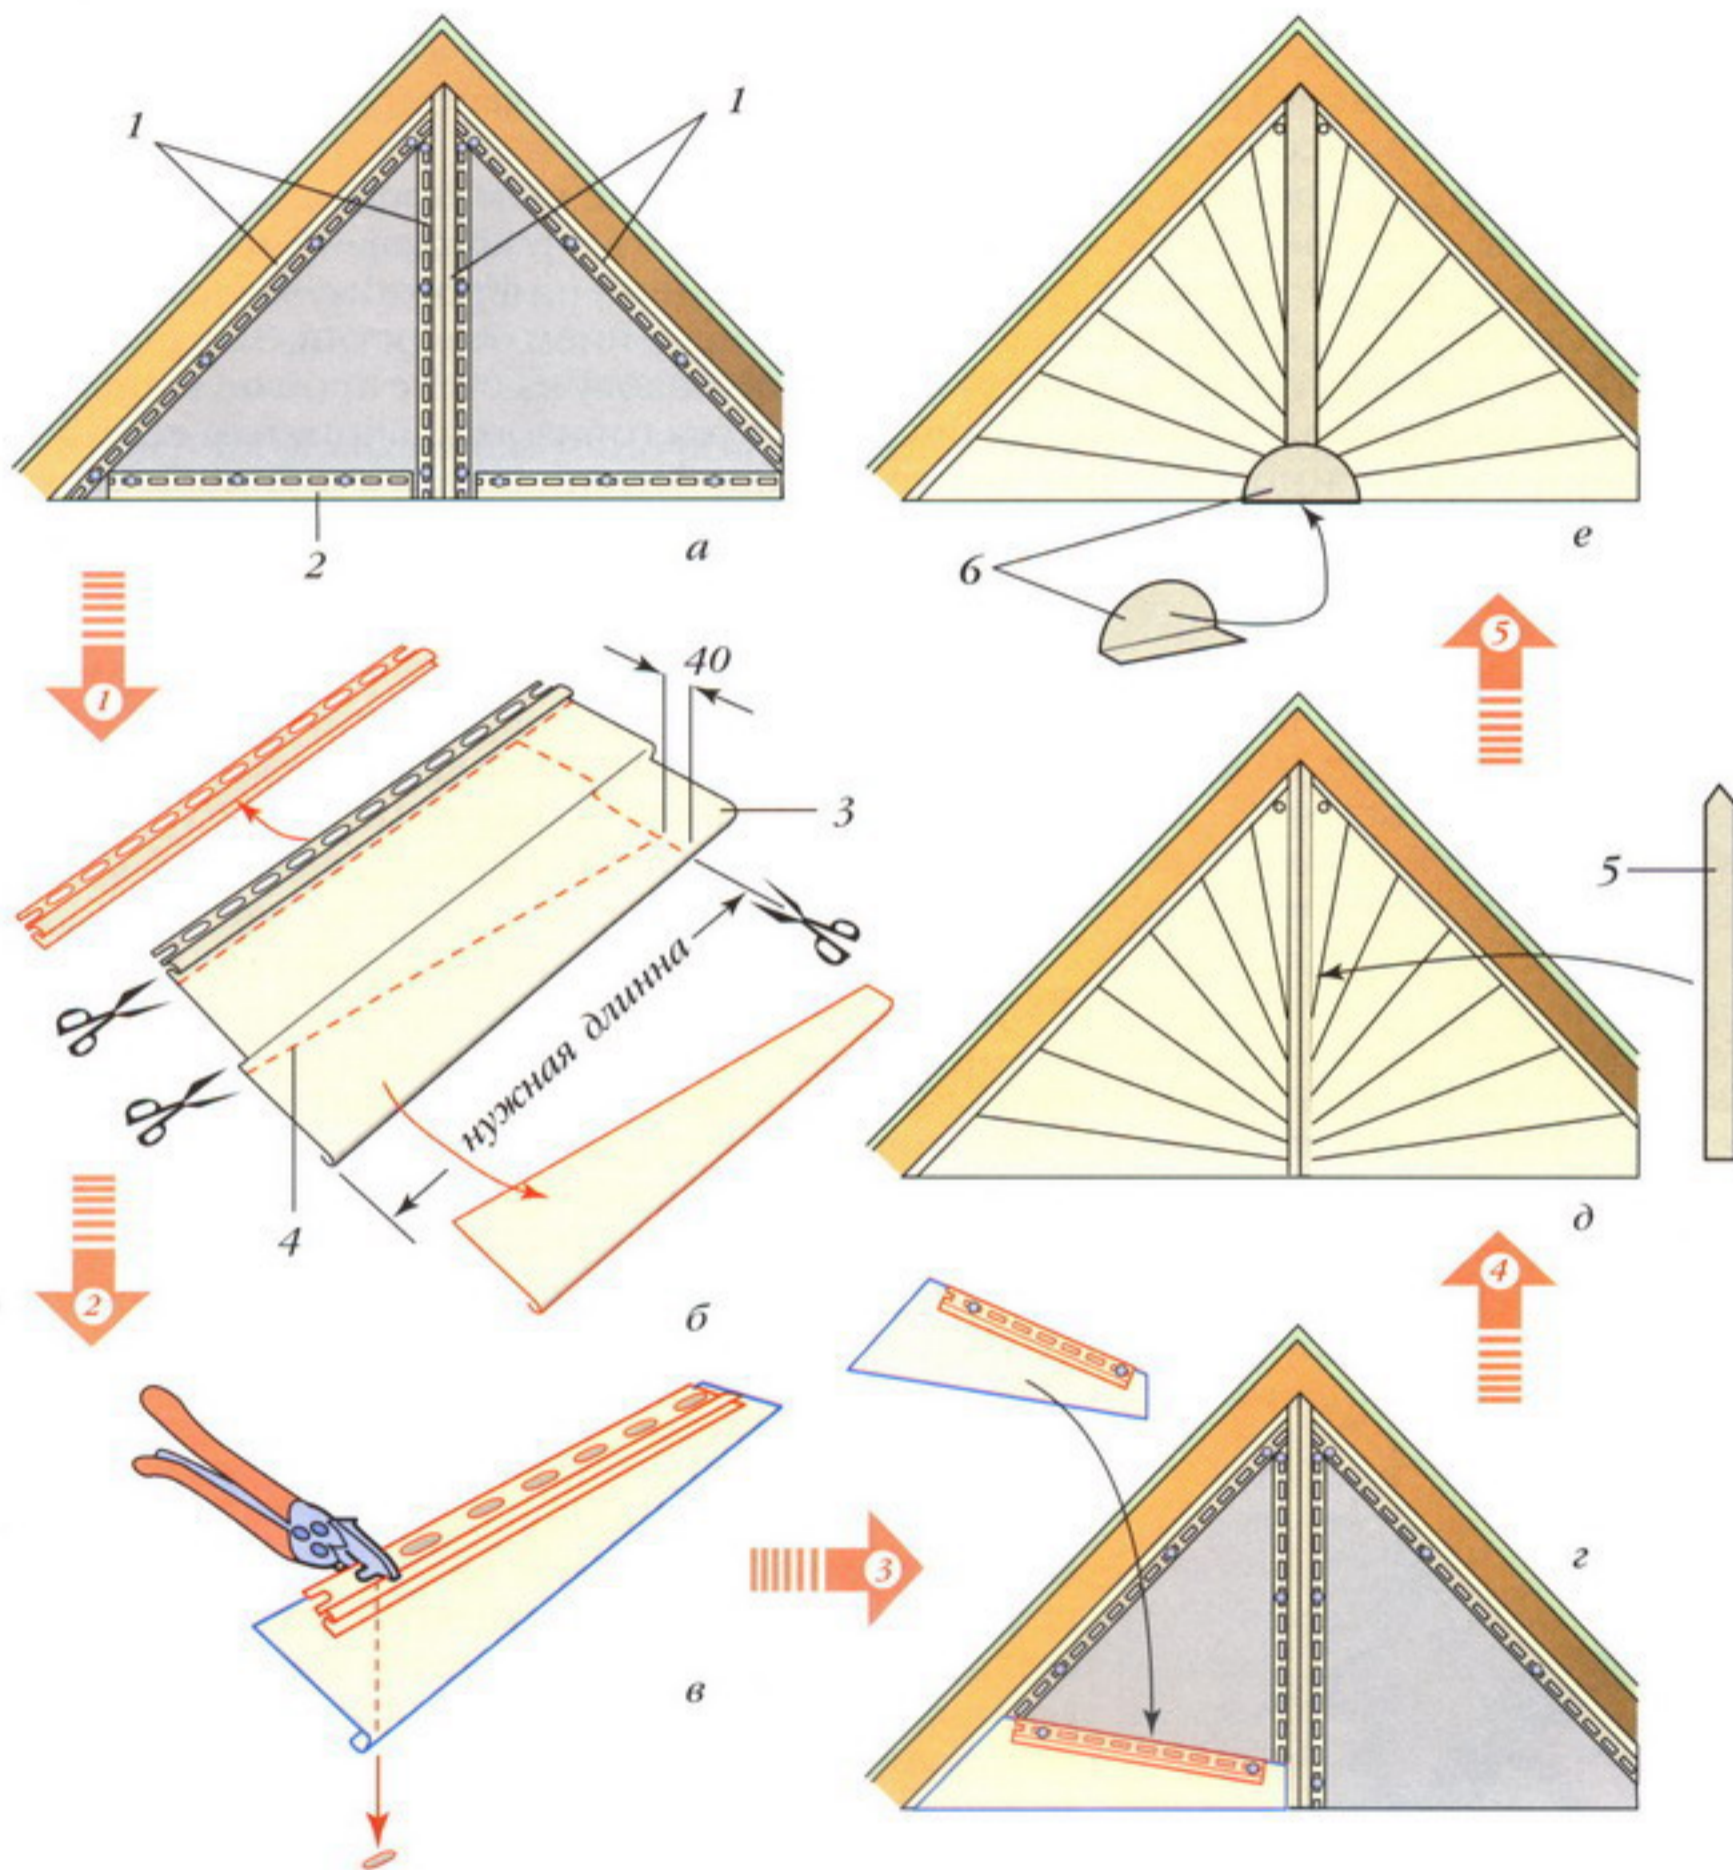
Пример изготовления декоративной виниловой обшивки «солнце» (размеры в мм): а — установка профилей обвязки фронтона; б — изготовление «луча»; в — пробивка на луче гвоздевых отверстий; г — монтаж лучей; д — монтаж центрального луча; е — монтаж солнечного диска; 1 — J-профили; 2 — стартовая полоса; 3 — кусок рядового сайдинга; 4 — линии разрезов; 5 — центральный луч; 6 — солнечный диск
